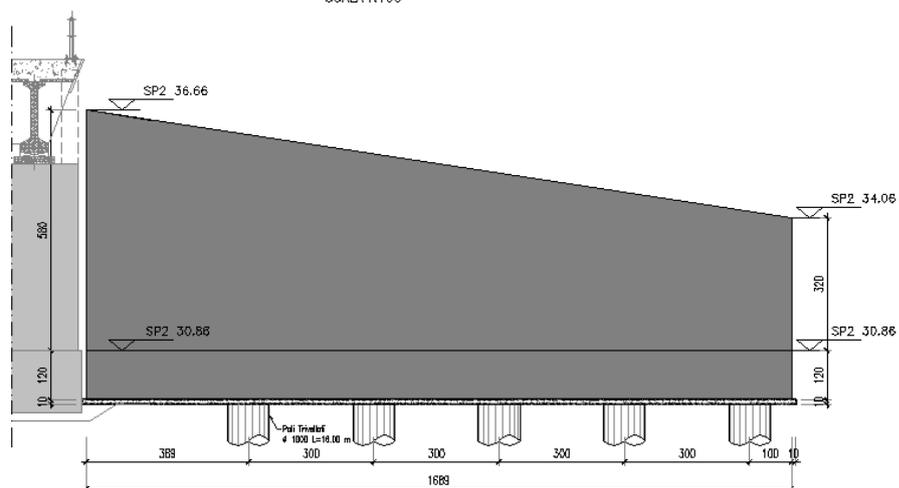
Planimetria fondazioni e prospetto muro contenimento lato Spalla 2 dx
